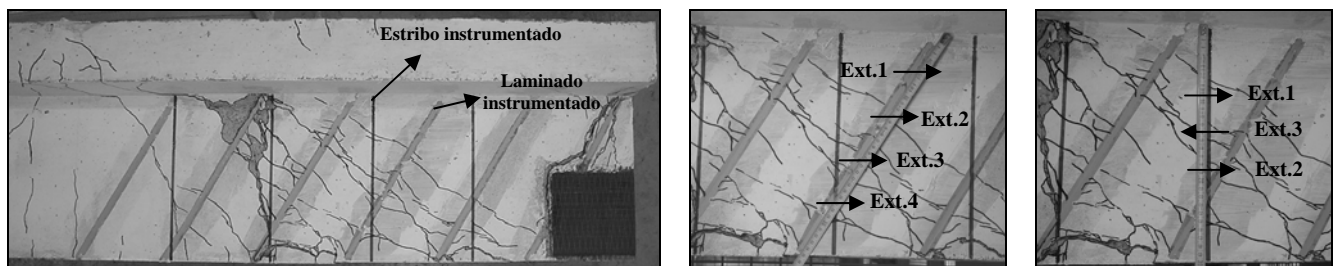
Localização dos extensómetros no laminado e estribo instrumentados da viga 4S-6LI60-B.
